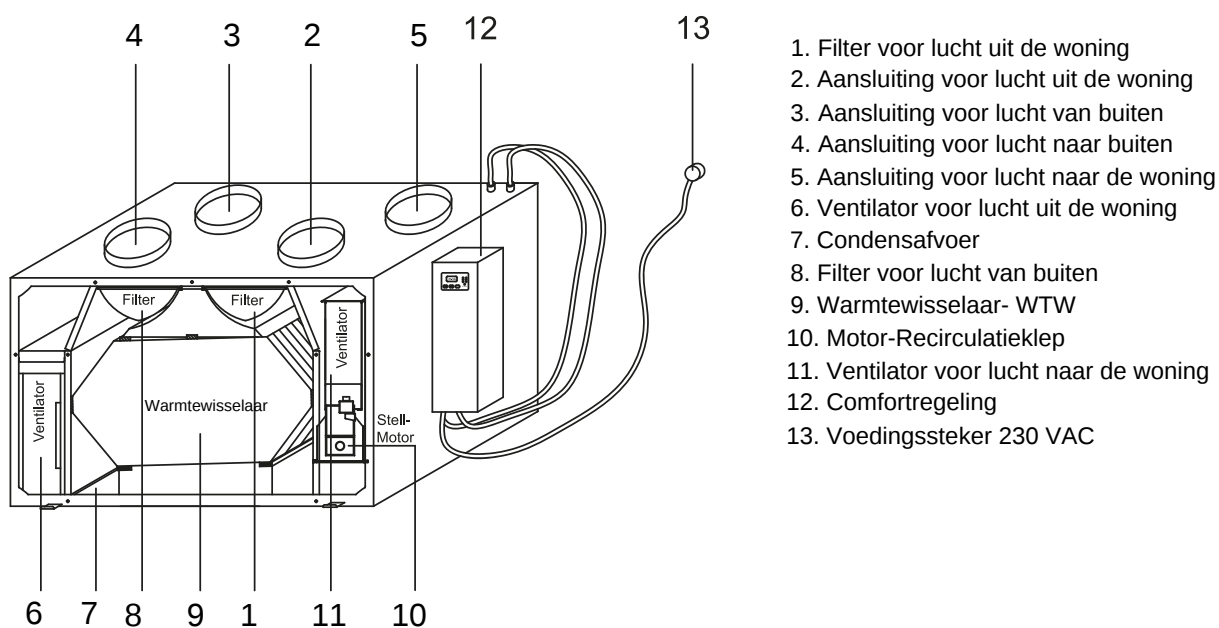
Voor- en bovenaanzicht EuroAir 400BY (met bypass, rechtse uitvoering)
